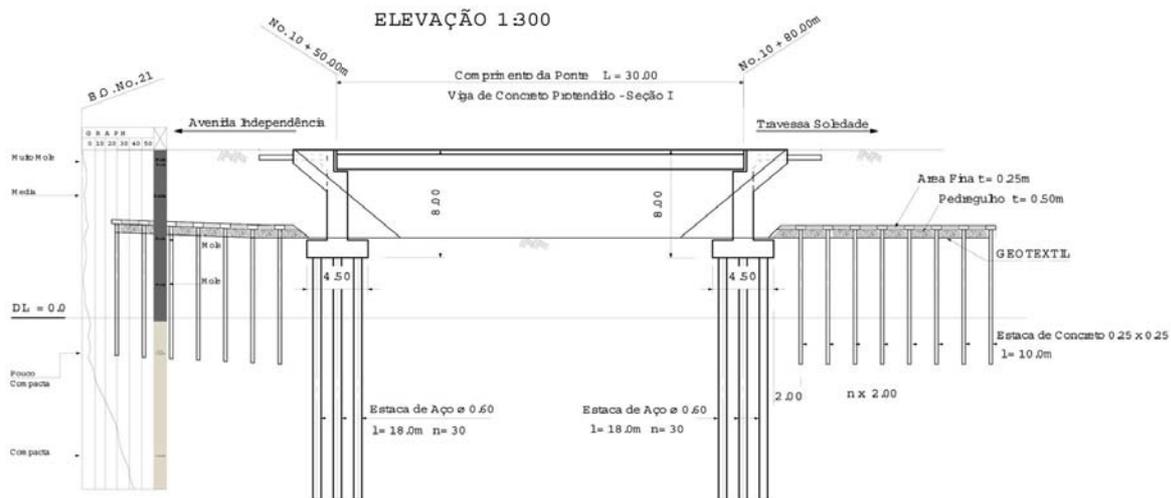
Seção Transversal Proposta da Estrutura das Pontes
